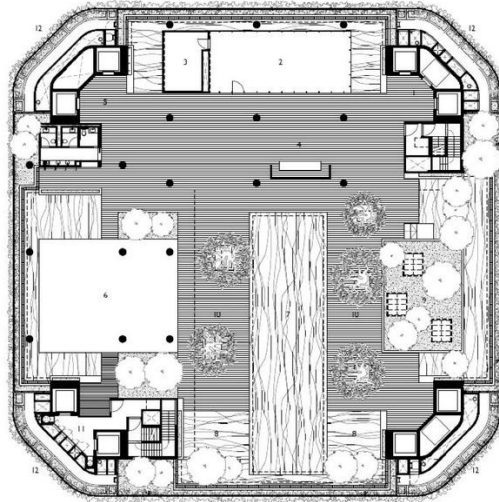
Denah Lantai 13 Oasia Hotel, Singapura
